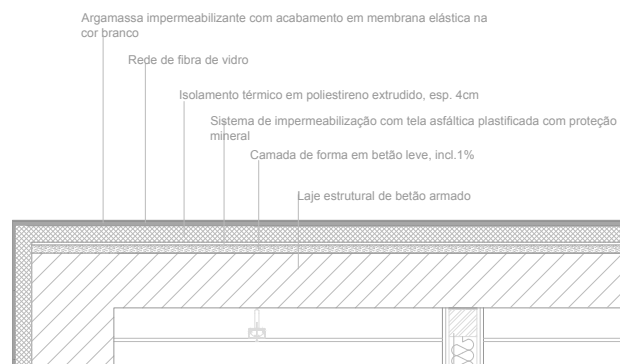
Corte da cobertura (sem escala) (Fonte Própria)
